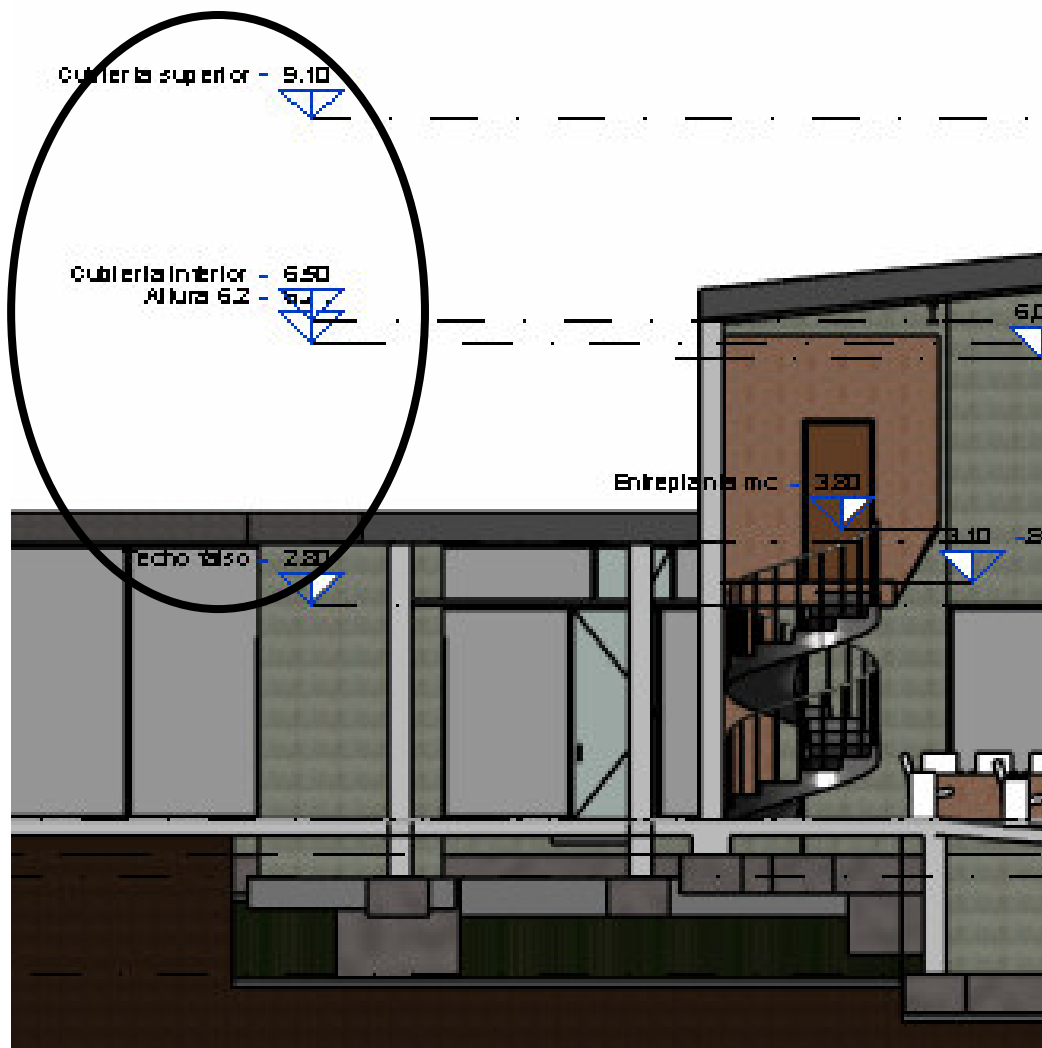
Detalle del alzado sur en el que se aprecian los niveles definidos en el edificio modelado
